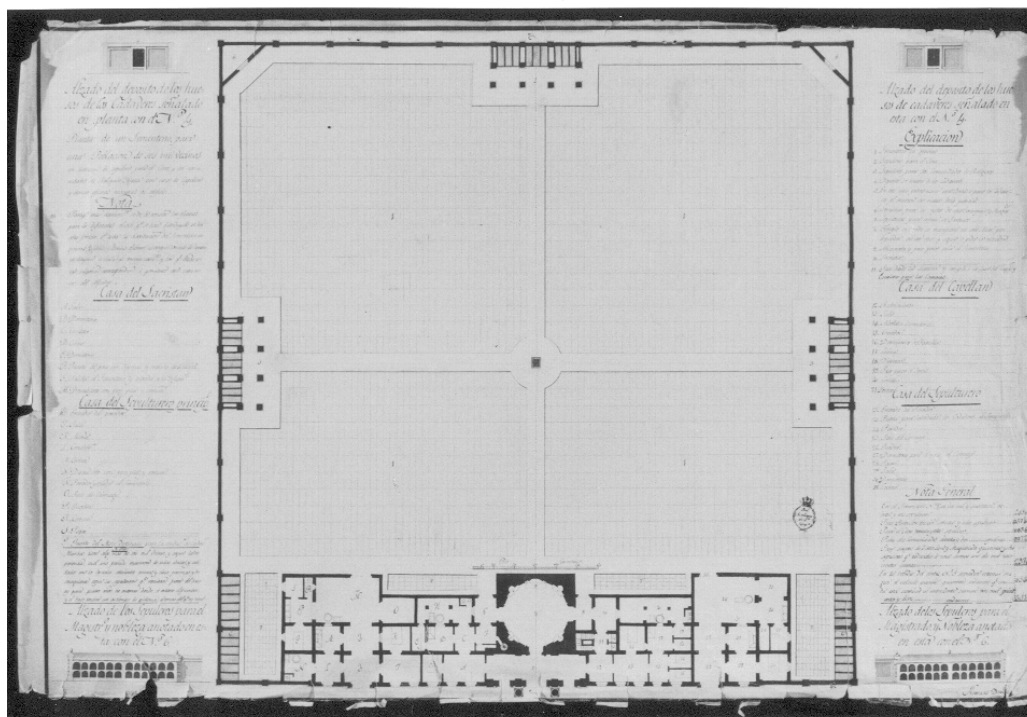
Planta de cementerio para Murcia de José Navarro David
